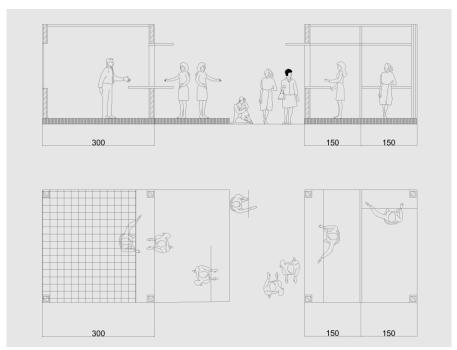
Potongan dan denah koridor 3 meter yang diapit oleh dua ruang niaga
